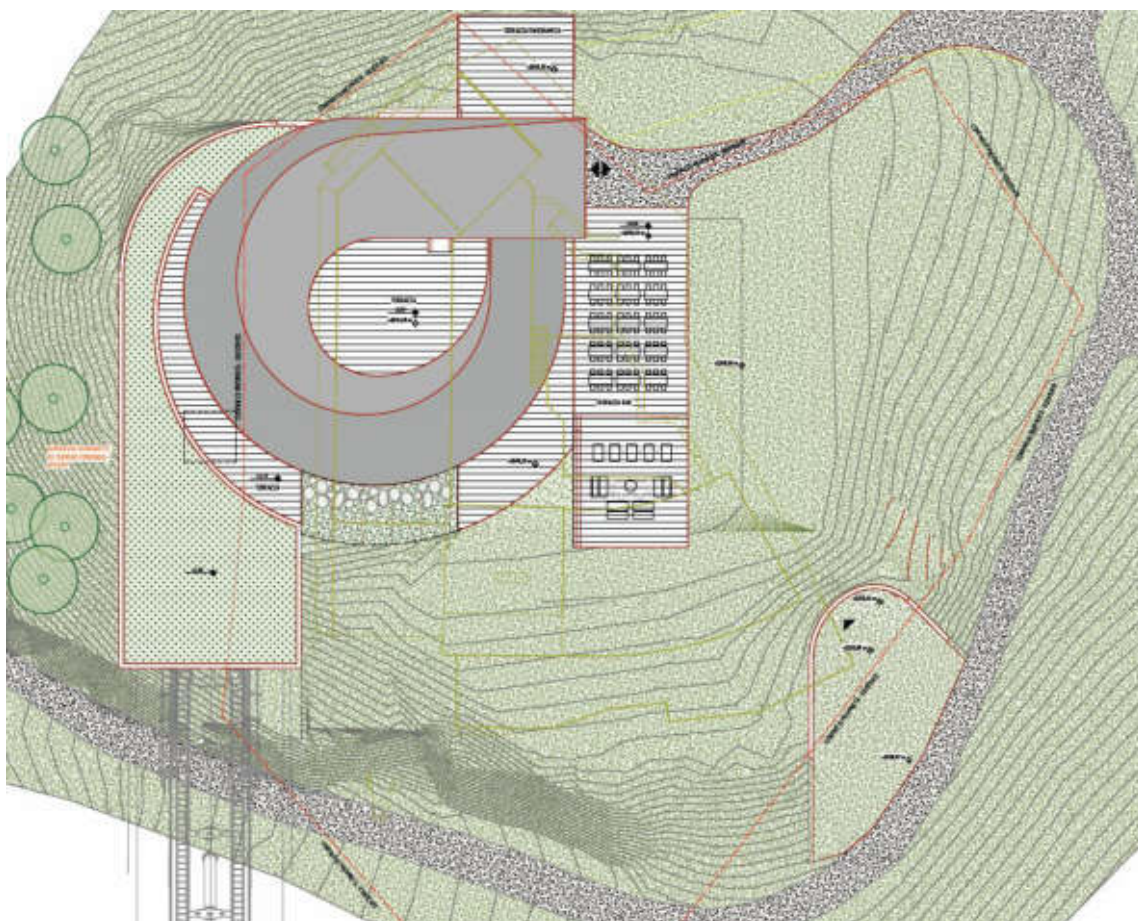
Projektauszug – Lageplan Bergstation (Arch. Sader) / stralcio da progetto – planimetria stazione di monte (Arch. Sader)
